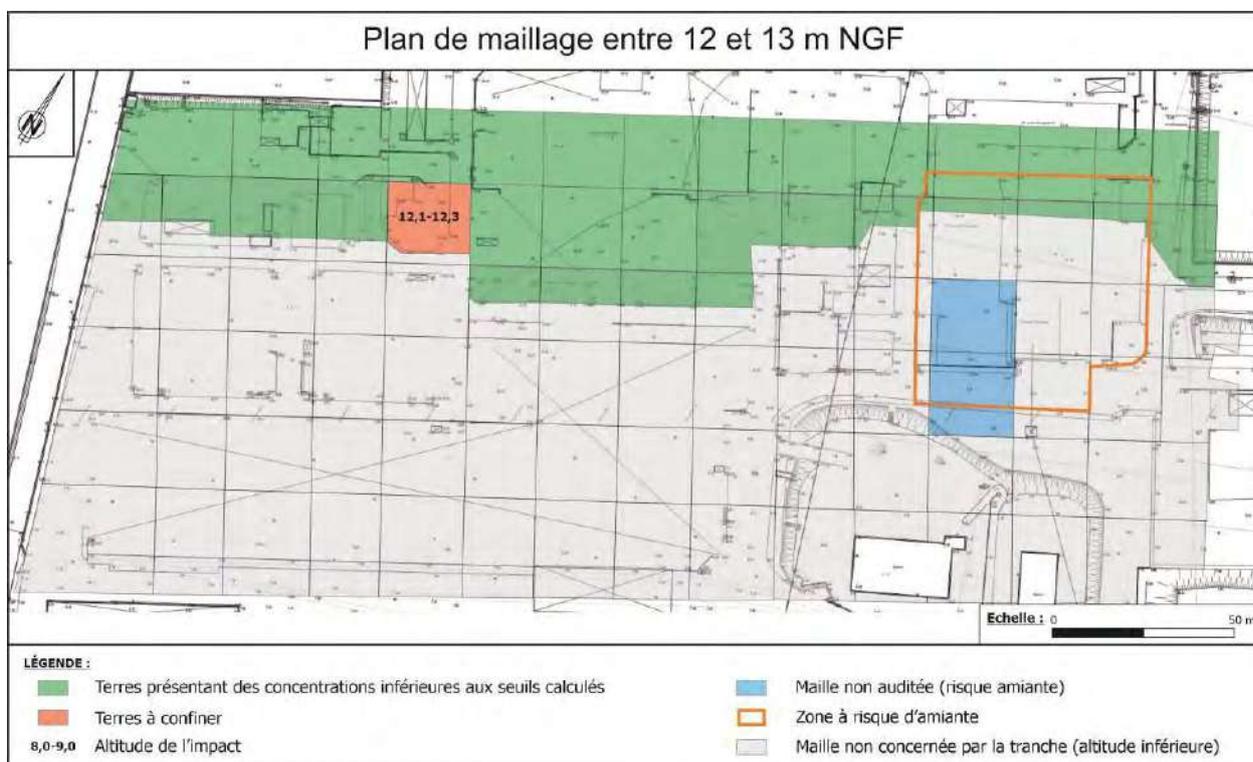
Plan de maillage entre 12 et 13 m NGF
